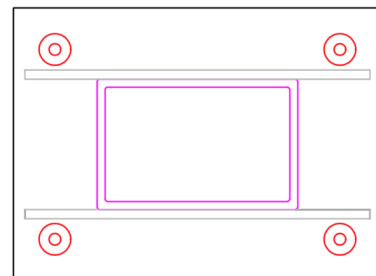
Section rectangulaire avec raidisseurs parallèles aux bords de la platine
